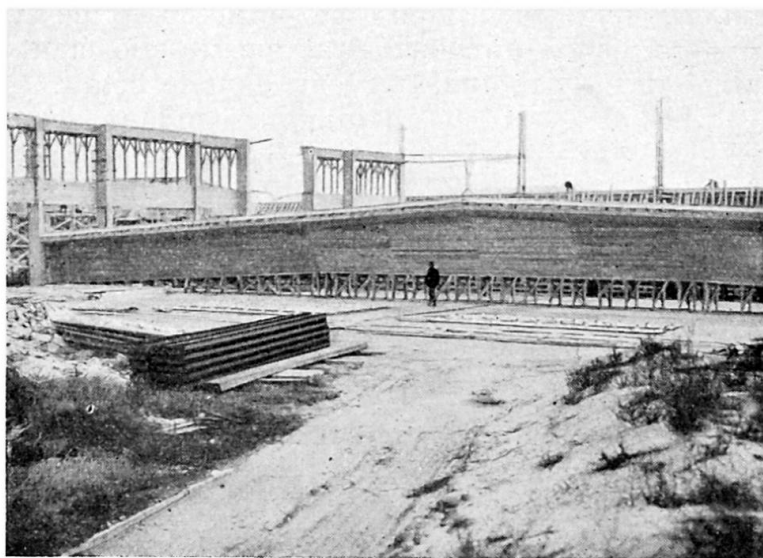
et 6. Chantier pour la construction d'un hangar d'aviation avec poutres de 50 mètres de portée.
